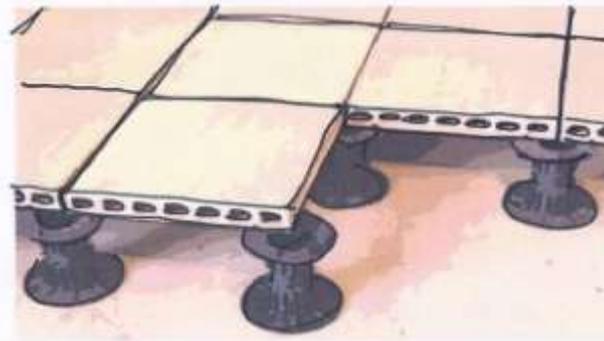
Pavimento flotante. Fuente: elaboración propia
